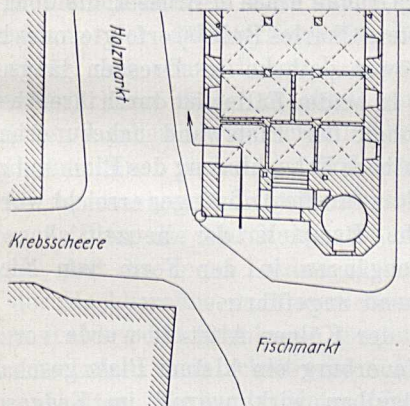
Halberstadt: Rathaus, seitlicher Durchbruch zur Verkehrsverbesserung, Grundriß.
